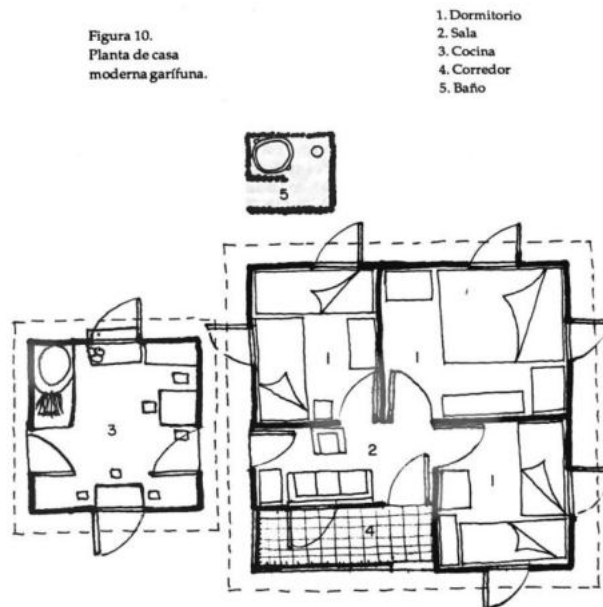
Planta de casa moderna garífuna Fuente: (Salinas, 2002)
